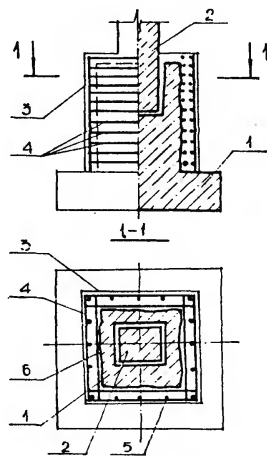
Устройство железобетонной обоймы вокруг подколонника
